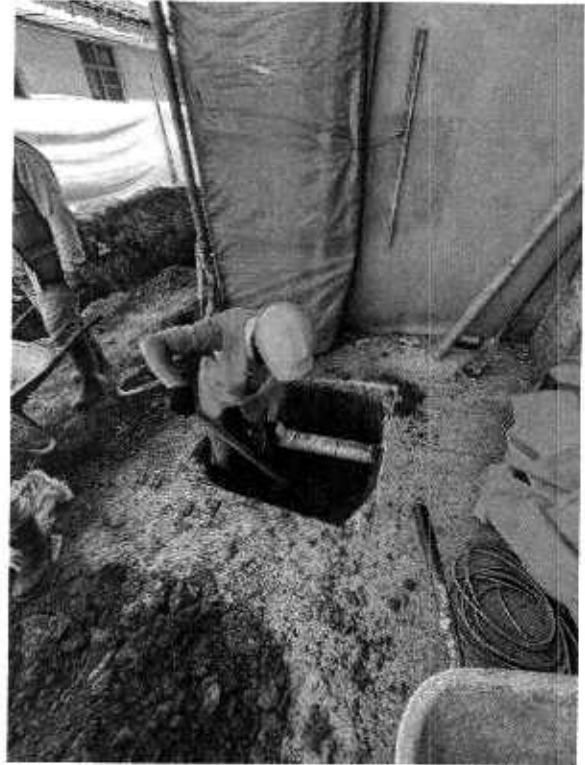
Excavación para tubería central Foto N° 8: Excavación para tubería central
